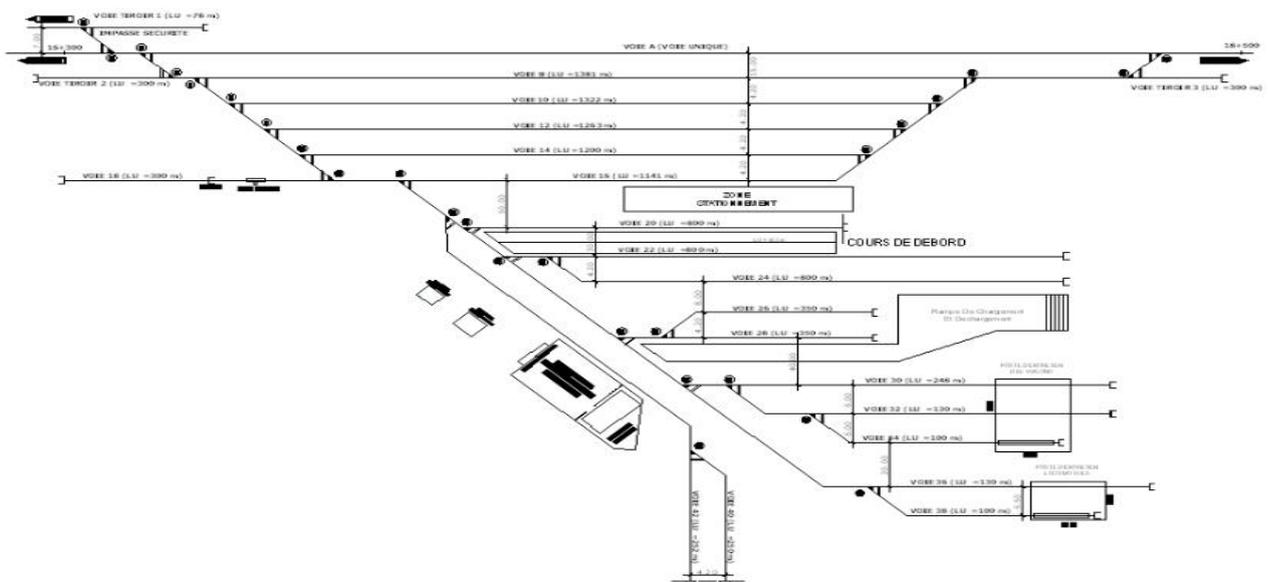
Plan d'appareils de type Gare de marchandises.
